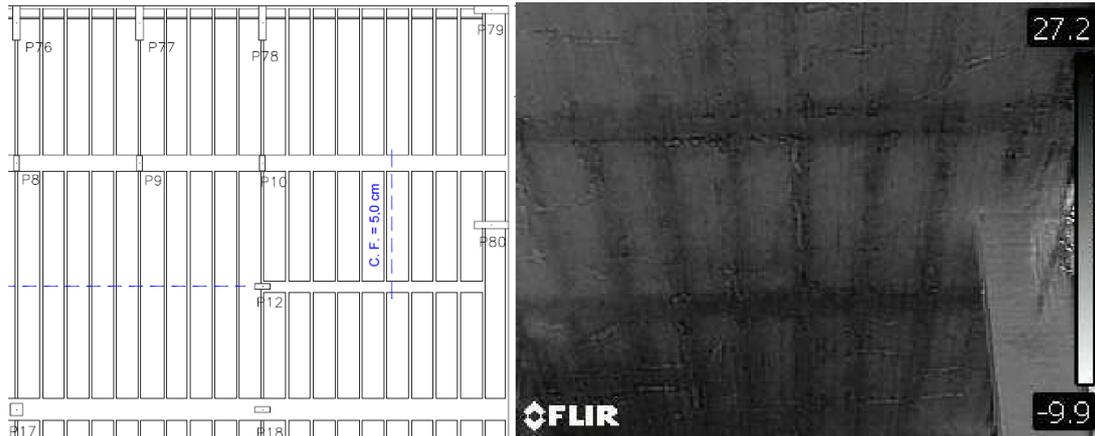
Planta da cobertura – detalhe nas proximidades do pilar P80 e evidências das vigas em comparação com o projeto
